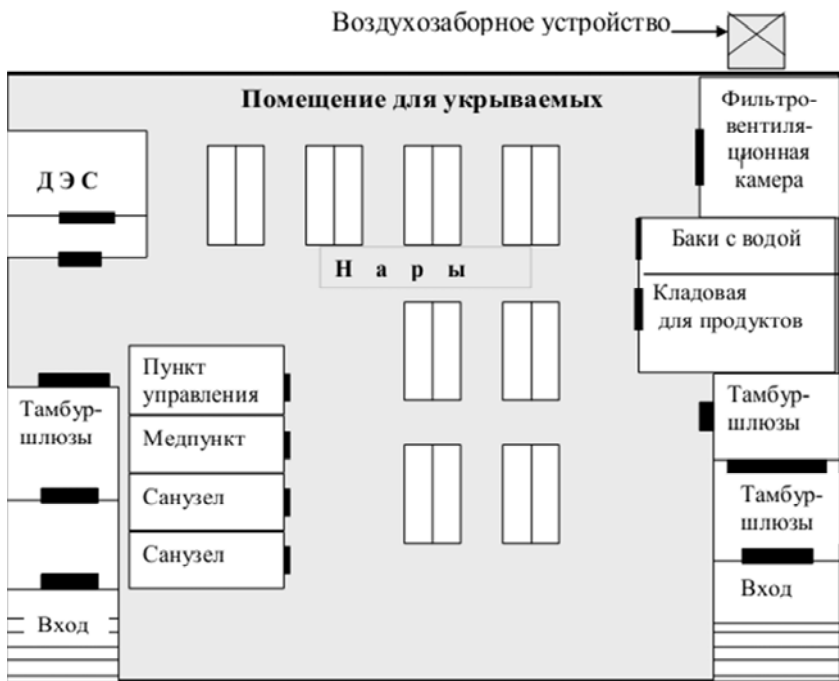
Планировка отдельно стоящего убежища (вариант)
